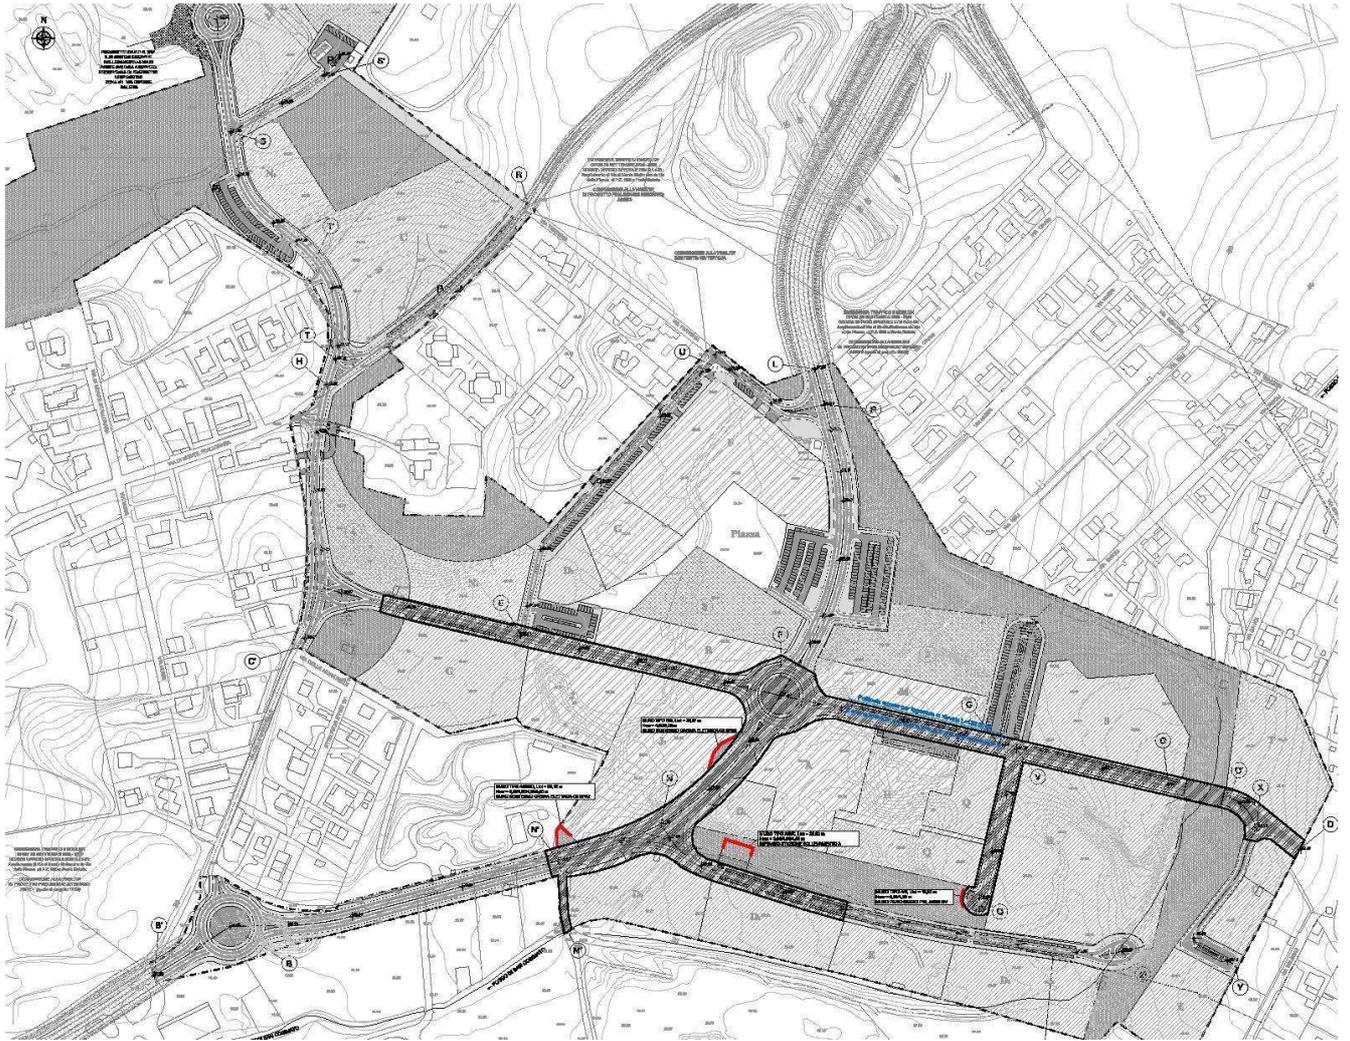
PLANIMETRIA MURI PROGETTO DEFINITIVO - 1°STRALCIO
